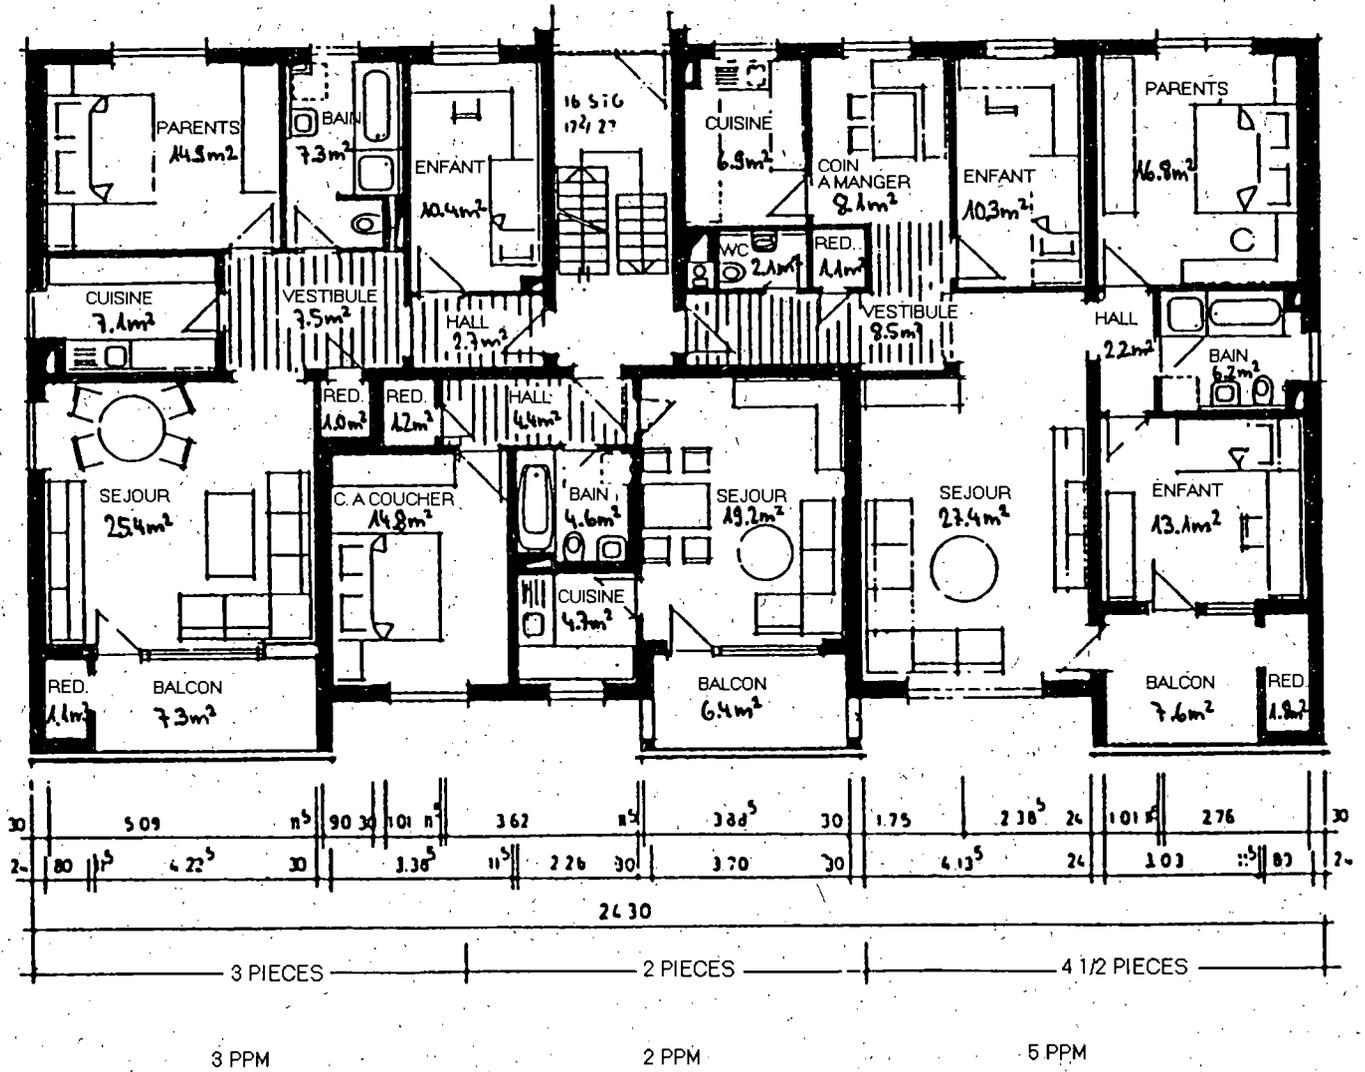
Plan du rez-de-chaussée, des 1er et 2e étages, Mühlengasse 3, Allensbach, (D)
